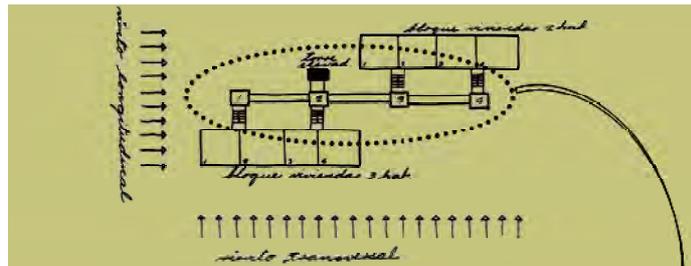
Detalles de la plataforma sobre la cual se asienta la edificación.
